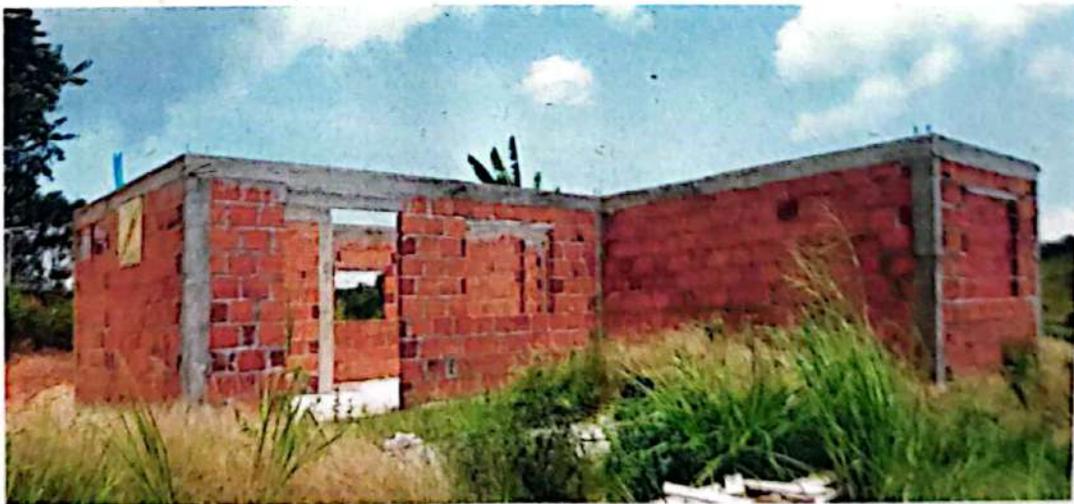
fachada lado Norte, muros terminados en mampostería de ladrillo a la altura de Viga Corona, se observan vanos de baños y vano alcoba.
